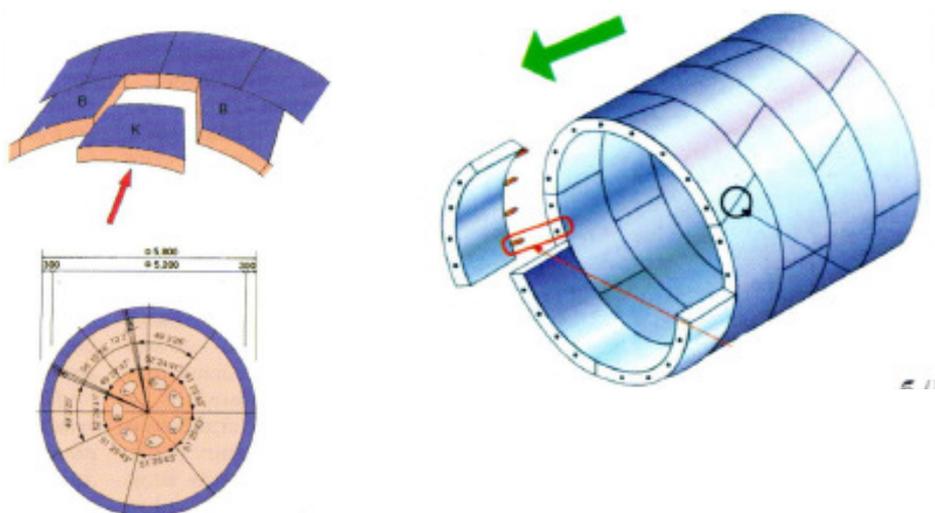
Konstruktion des U-Bahntunnels, der in geschlossener Bauweise ausgebaut ist
